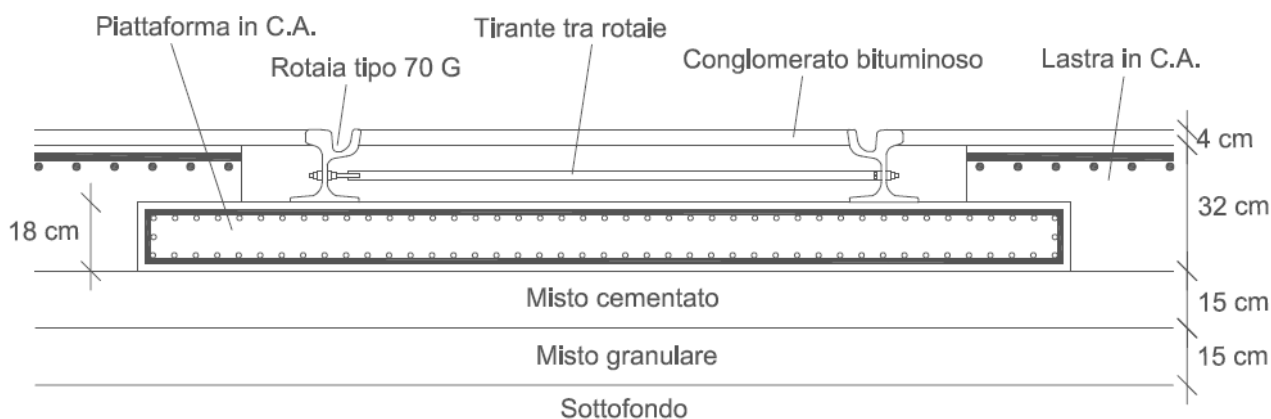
L – Pavimentazione polifunzionale con rotaia a gola inclusa
